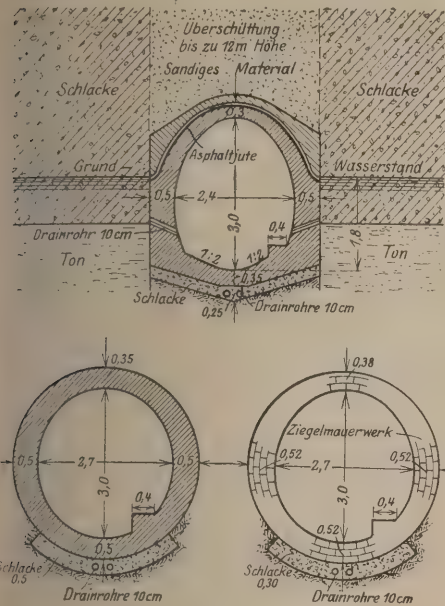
Hörder Tunnel. Bauausführung bei offener Aufgrabung.
